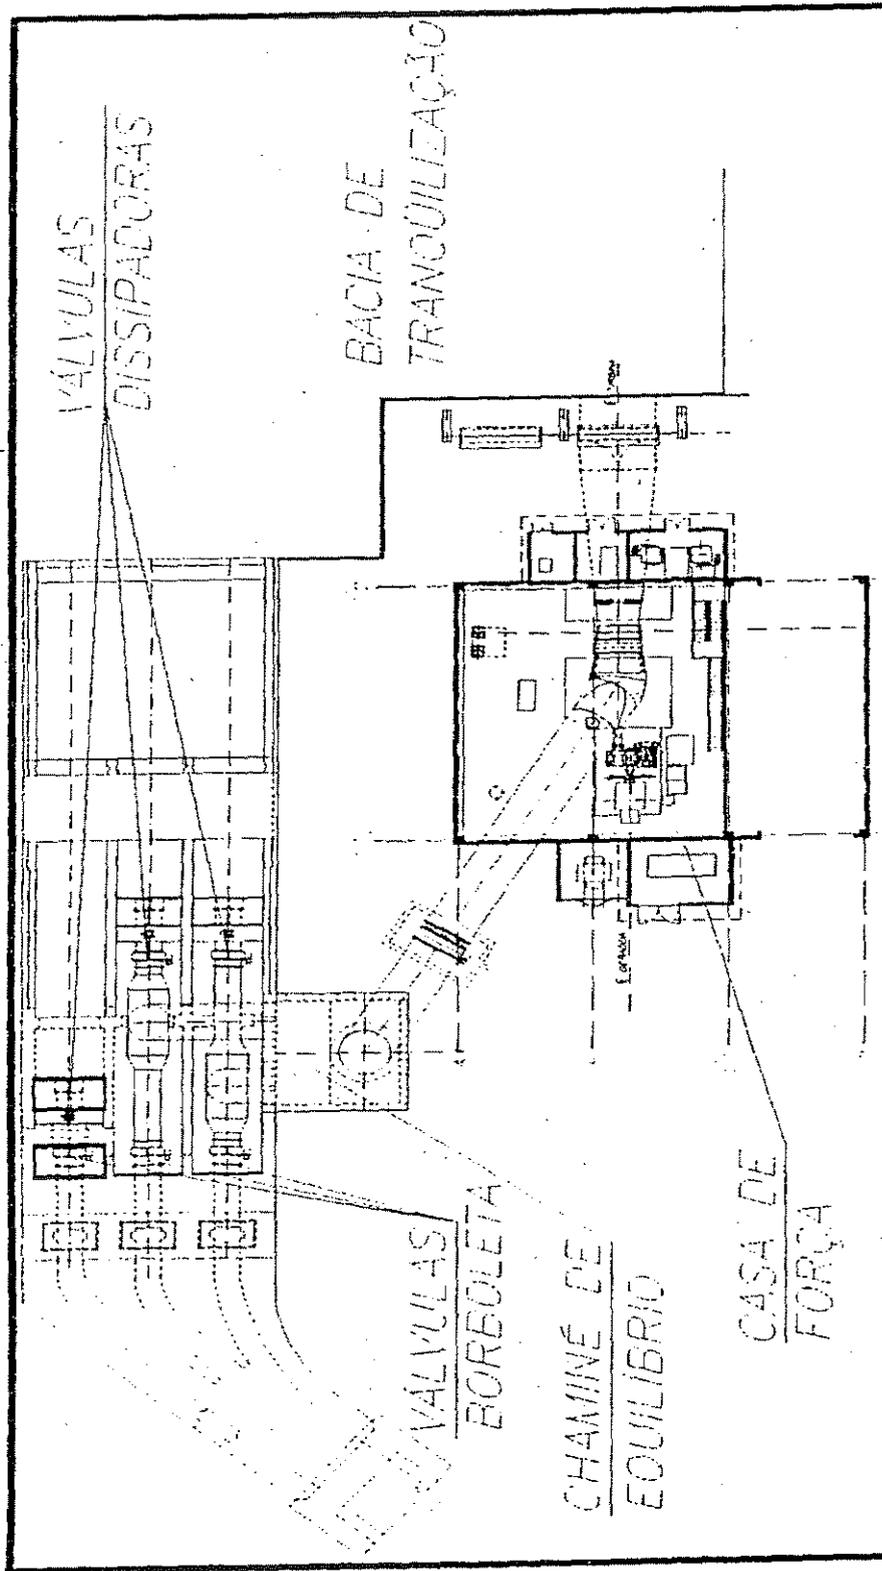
Planta de Alternativa Básica – PCH – Guaraú – (SABESP – 2004)
